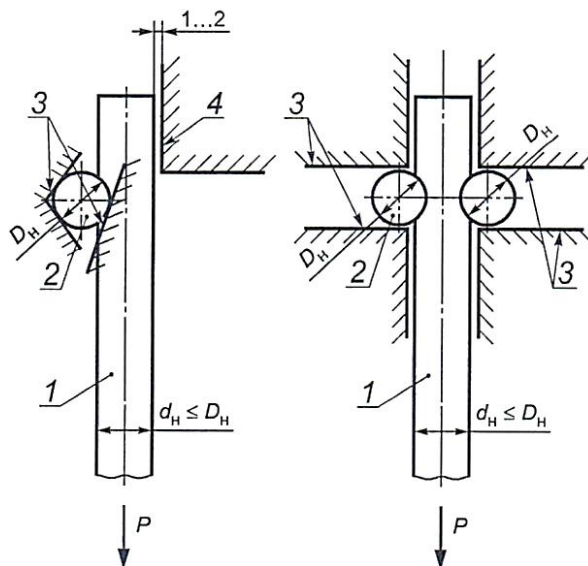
Схемы испытаний крестообразных соединений на срез:
